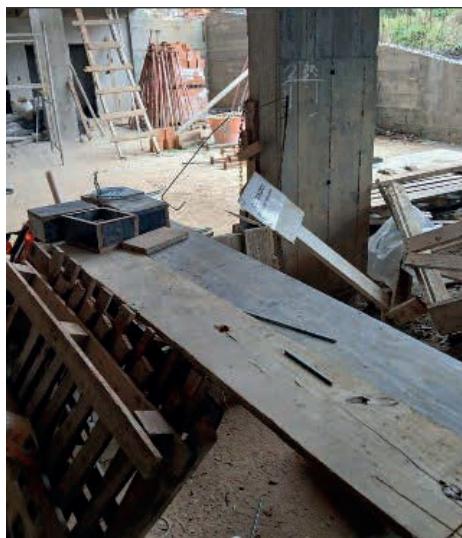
Condições de organização do canteiro observadas na primeira visita.
